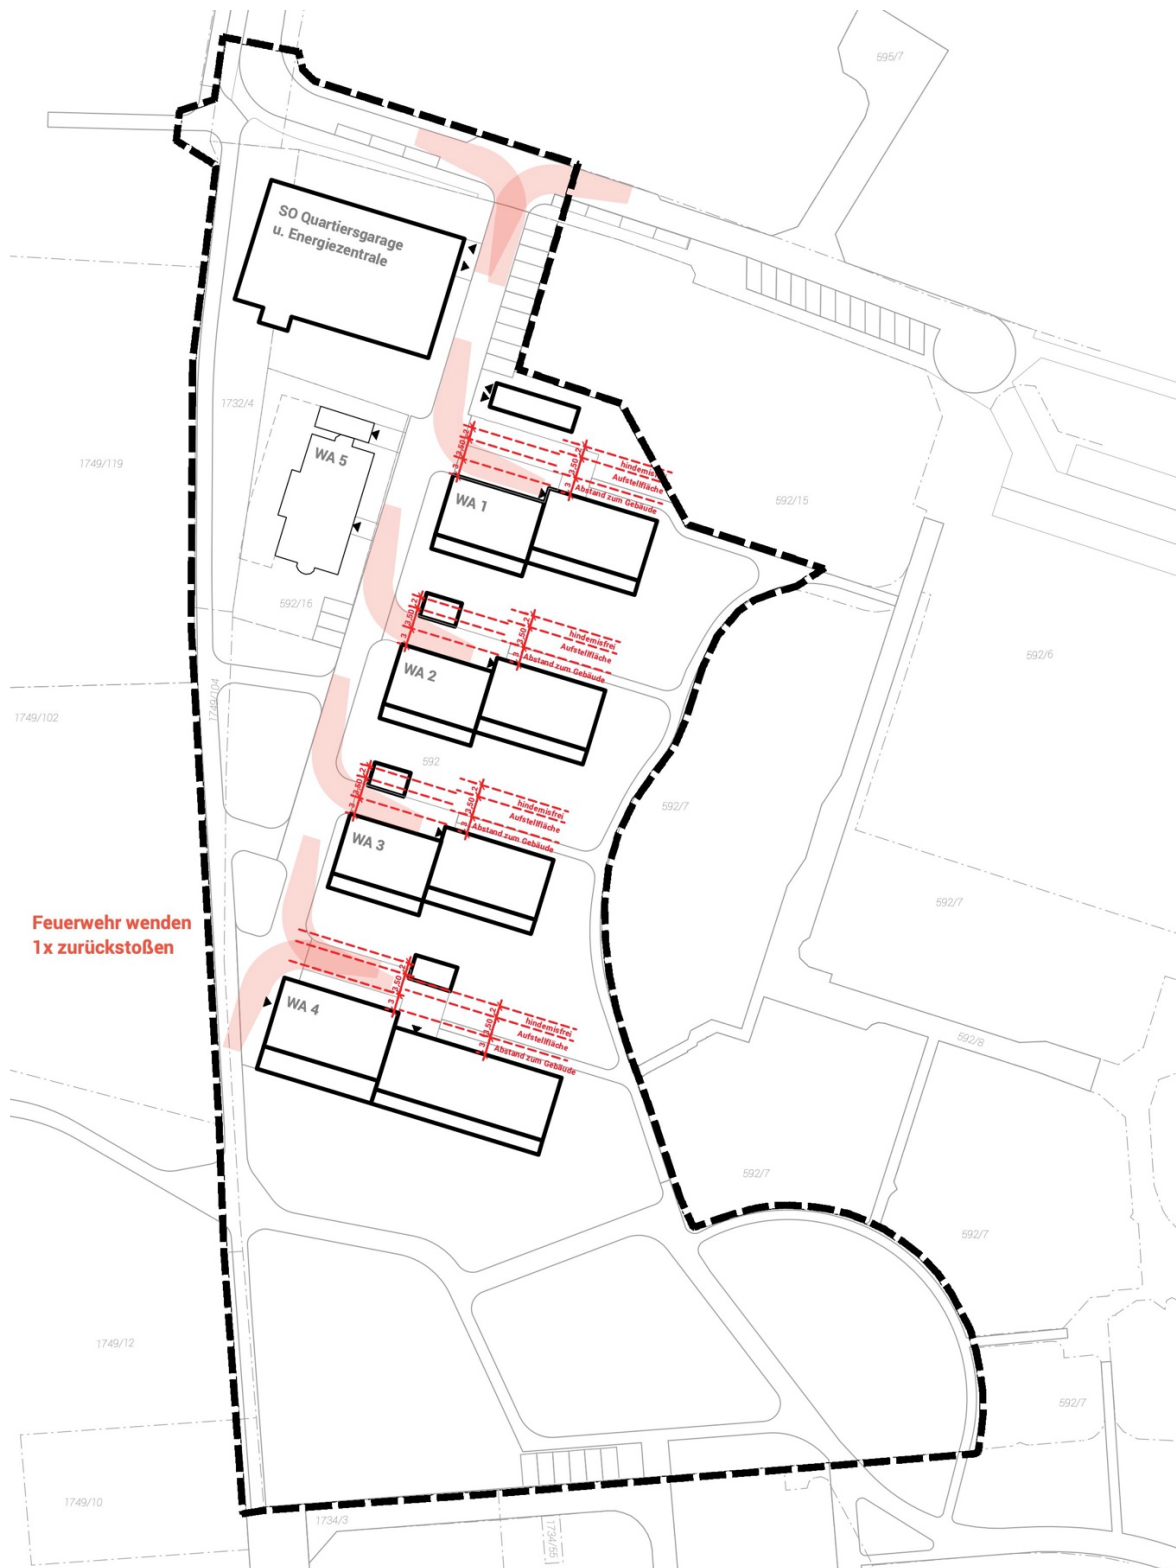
Feuerwehruzufahrt und mögliche Feuerwehrumfahrungs- und -aufstellflächen
